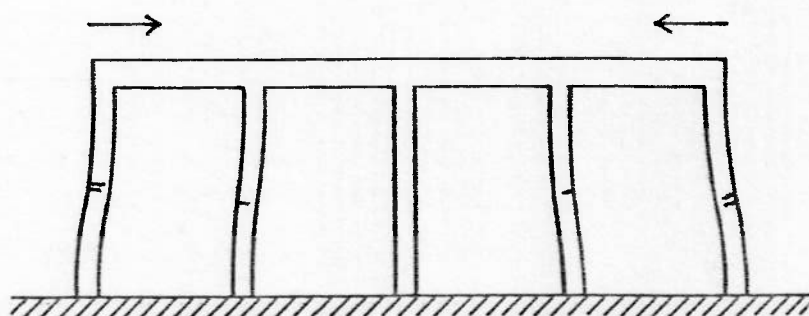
Fissuras horizontais nos pilares, devidas à retração do concreto das vigas superiores
